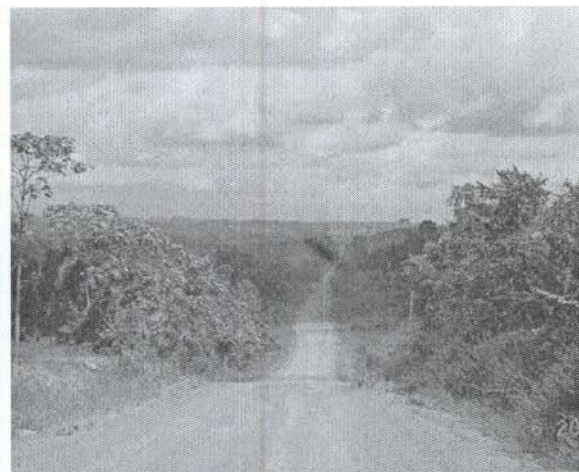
Bueiro ARMCO instalado emergencialmente na área da Figura 65.
